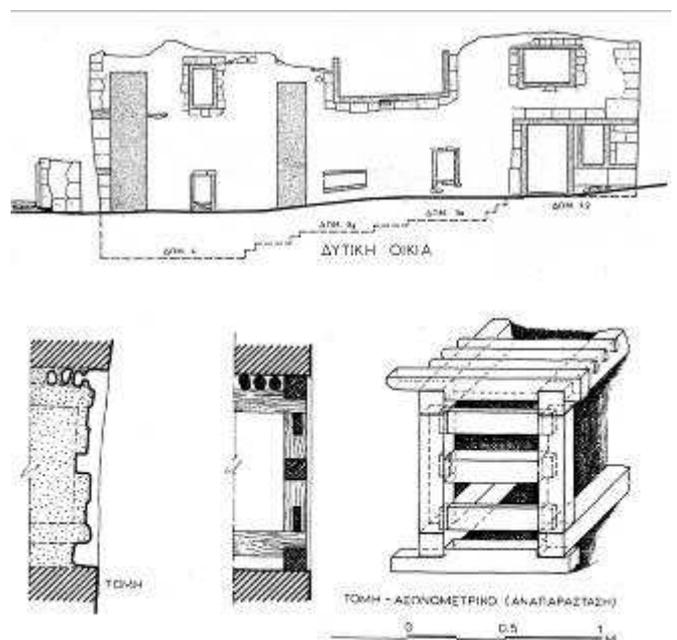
Akrotiri (Santorini). Casa ovest. Sopra: prospetto del lato sud. Sotto: ricostruzione del telaio ligneo di una finestra (PALYVOU 1990)
